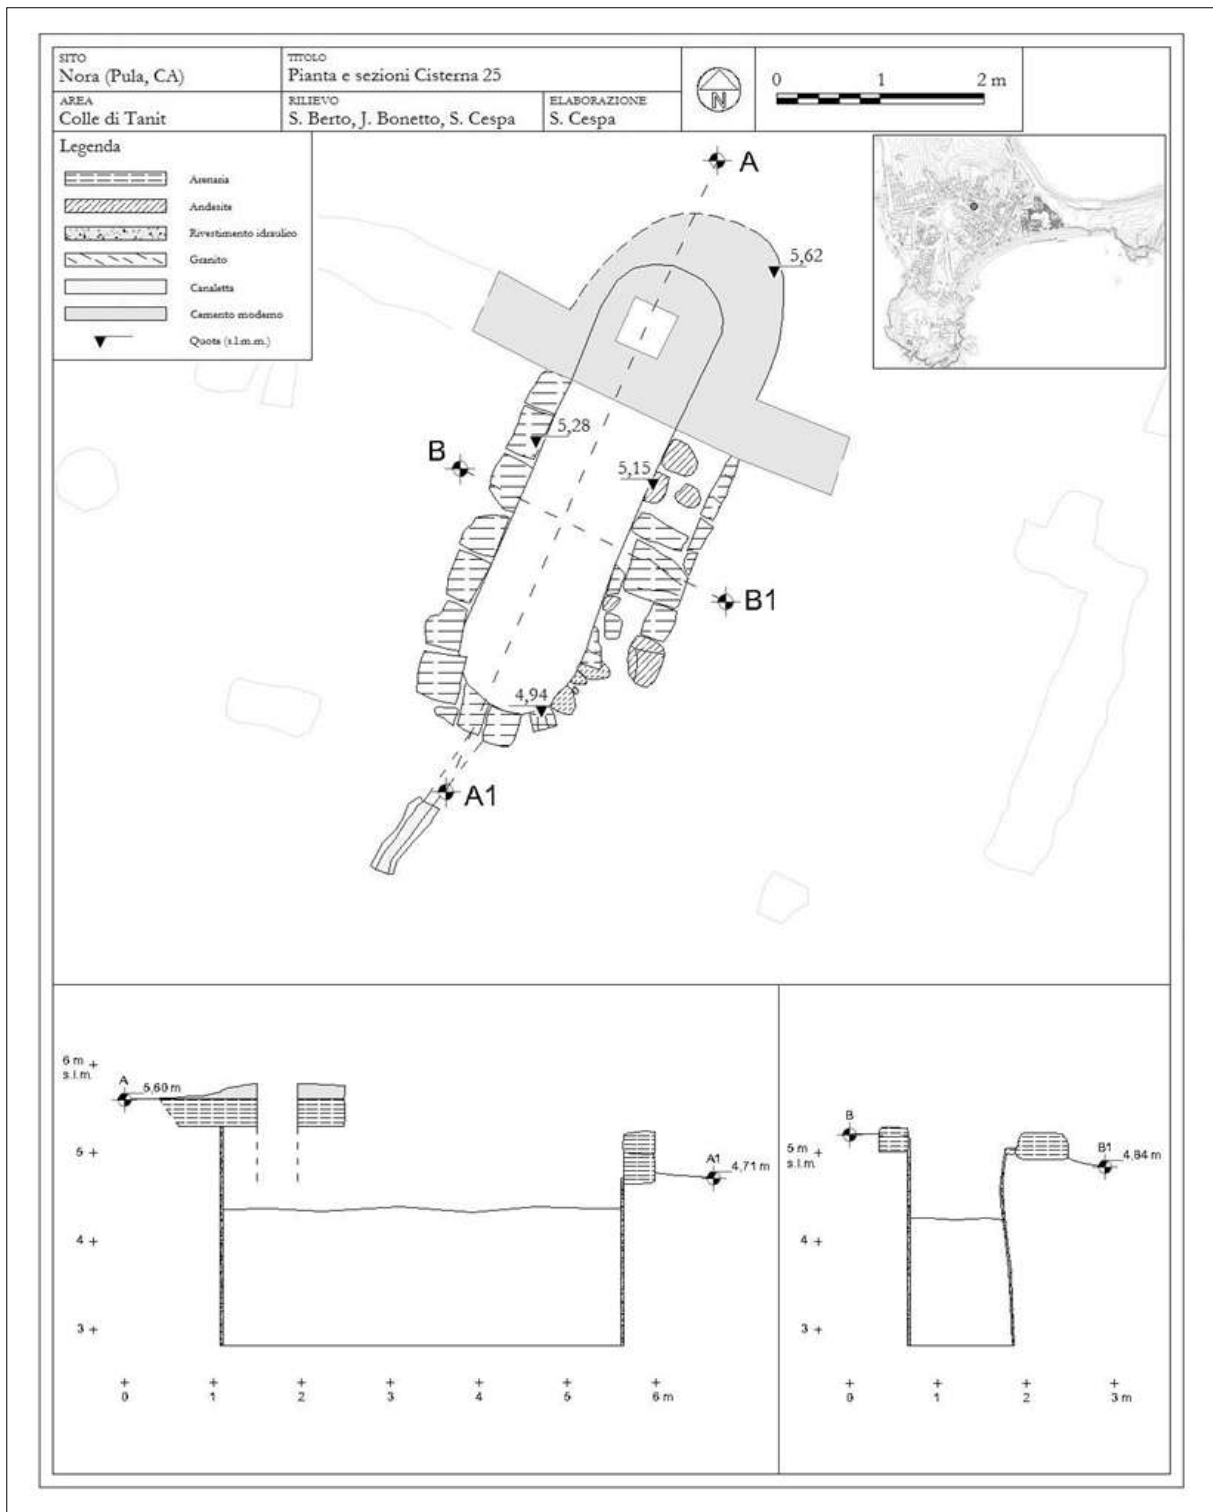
Pianta e sezioni della cisterna 25 (elaborazione dell'autore).
